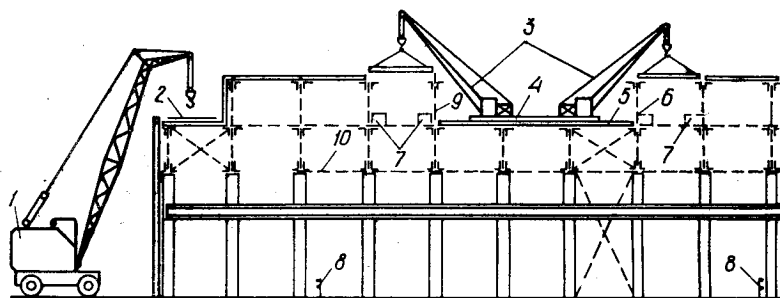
Замена конструкций фонаря крышевыми стреловыми кранами: 1 — самоходный стреловой кран; 2 — площадка складирования конструкций; 3 — крышевые стреловые краны; 4 — деревянный настил; 5 — подкрановый путь; 6 — демонтируемая ферма; 7 — подмости; 8 — ограждение опасной зоны; 9 — смонтированная ферма; 10 — подфонарная сетка
